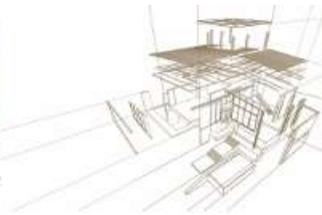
Plantas, Fachadas y detalles estructurales – Vivienda en Solanas
